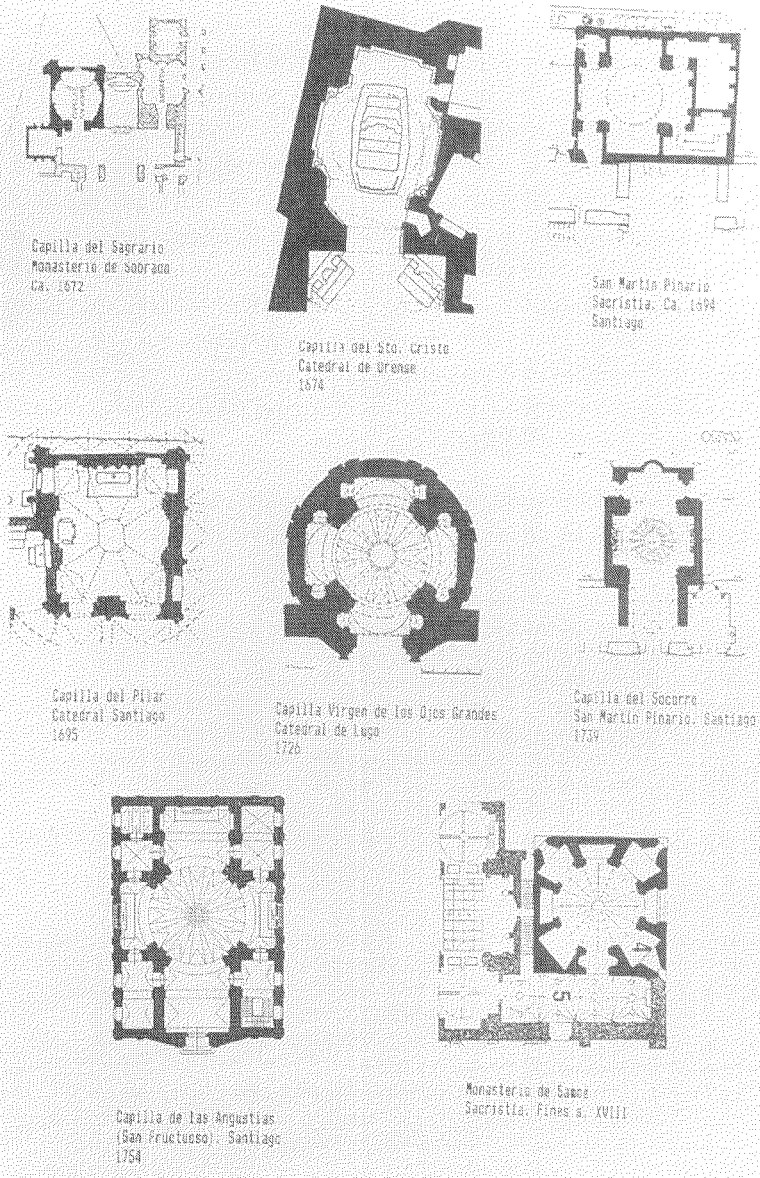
Plantas de construcciones gallegas de plan central. Siglos XVII y XVIII.
